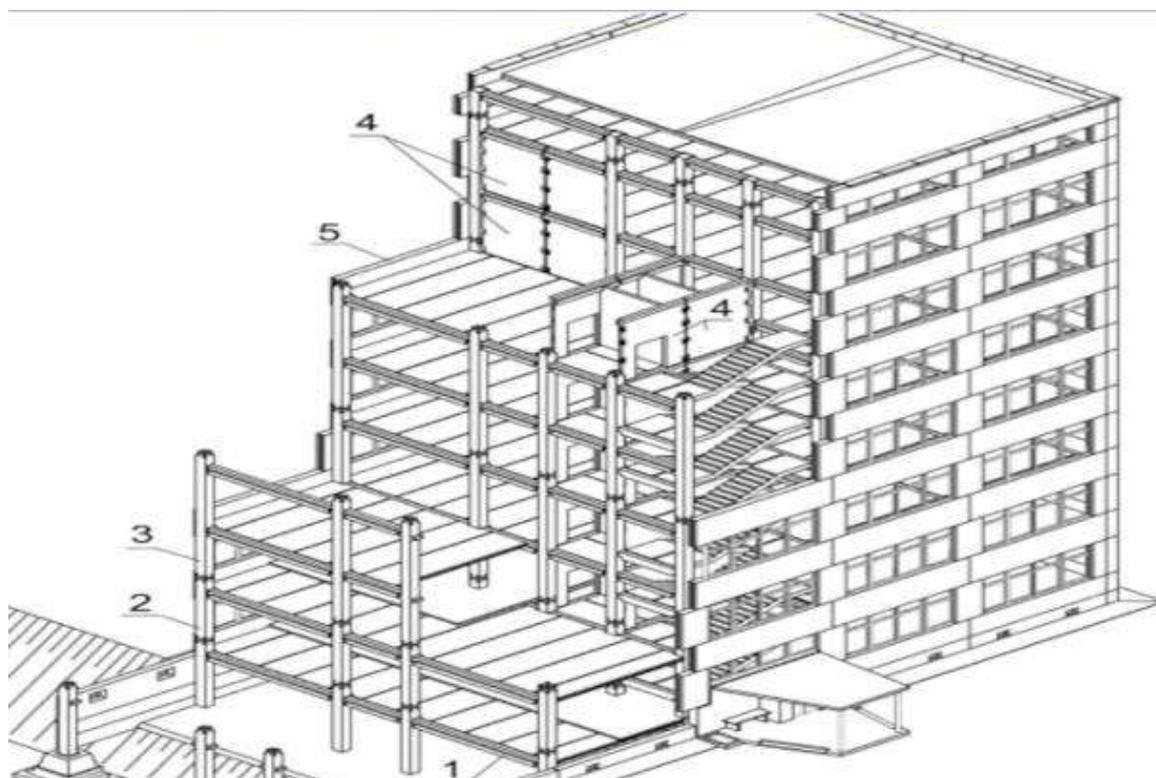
Конструктивне рішення типової багатоповерхової промислової будівлі: 1 – перекриття; 2, 3 – колони; 4 – вертикальні діафрагми жорсткості; 5 – навісні стінові панелі
